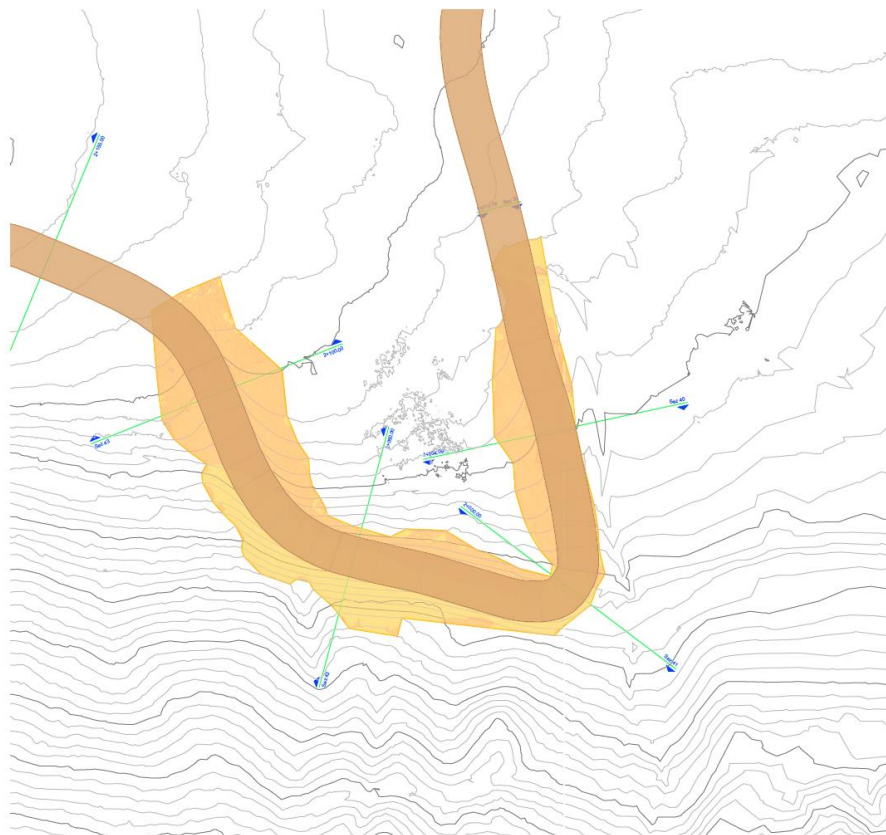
Estratto planimetria sterri e riporti - scala a vista
